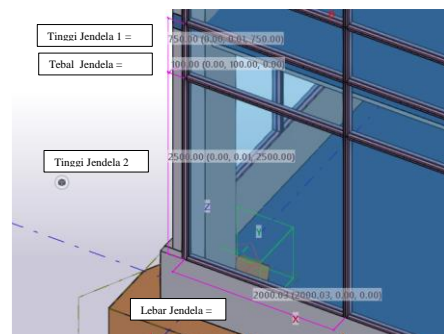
Metode Kerja Pemasangan Facade Certain Wall
